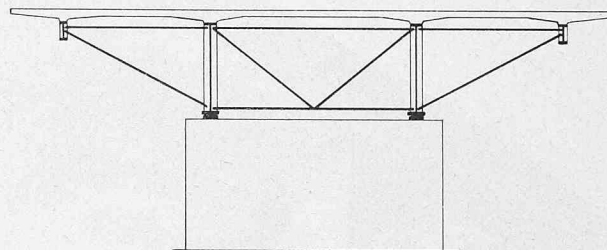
Pont avec un tablier appuyé sur quatre poutres, dont deux forment un caisson
